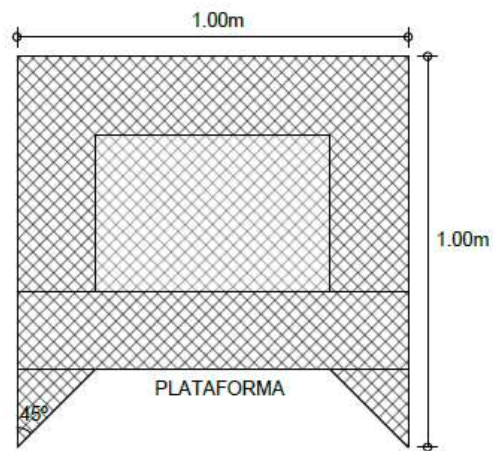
Corte (abajo) y planta (arriba) del sistema de recolección.
